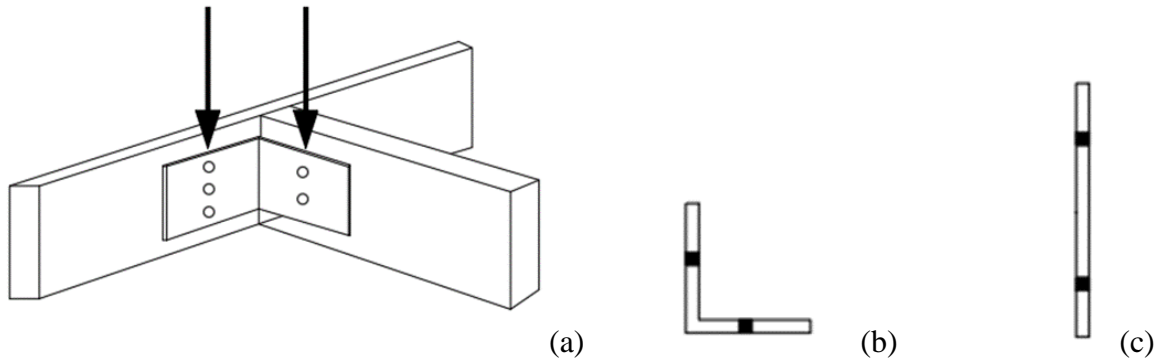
Modelo de ligação viga-viga e demonstração da linha de ruptura
